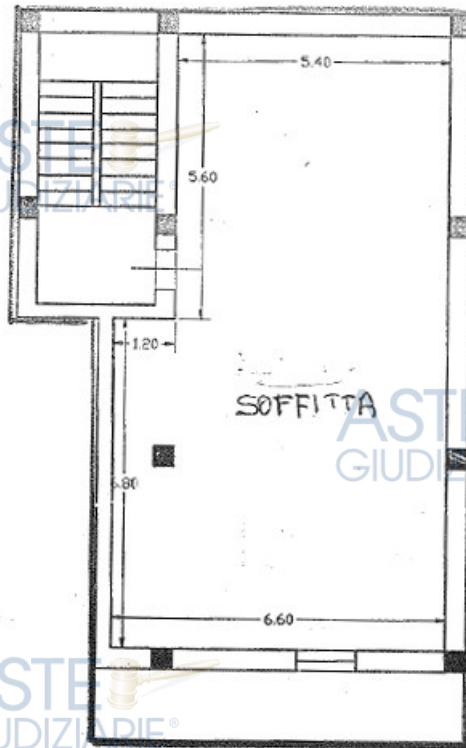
Planimetria in integrazione alla domanda di condono - Piano secondo - soffitta.
